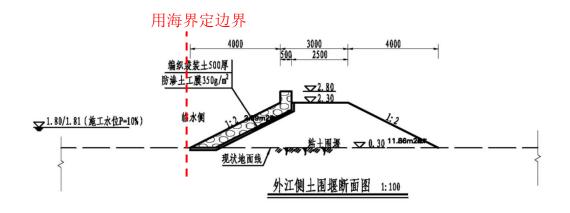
涵窦重建施工围堰断面图一用海界定示意图
